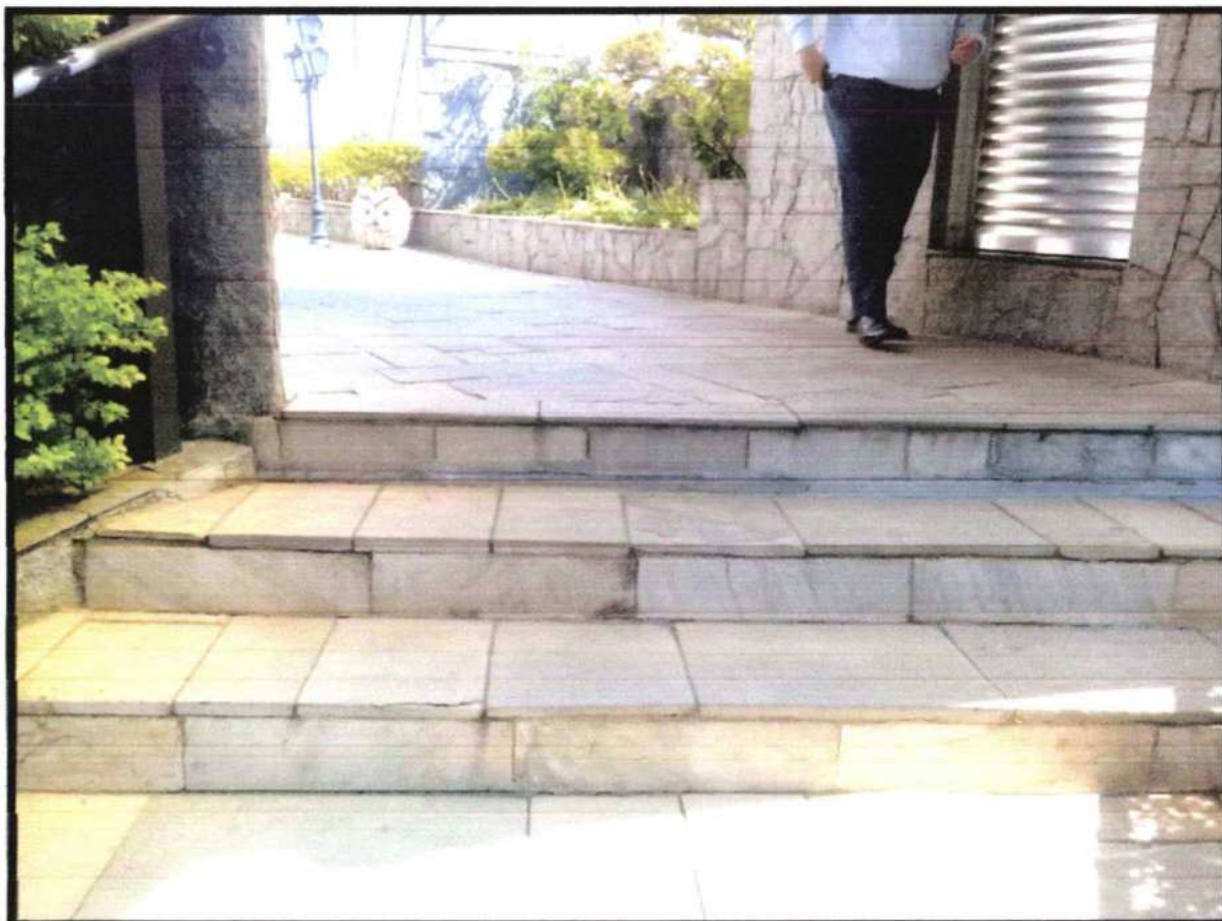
Escada de acesso e piso da passagem interna em pedras mineiras.
